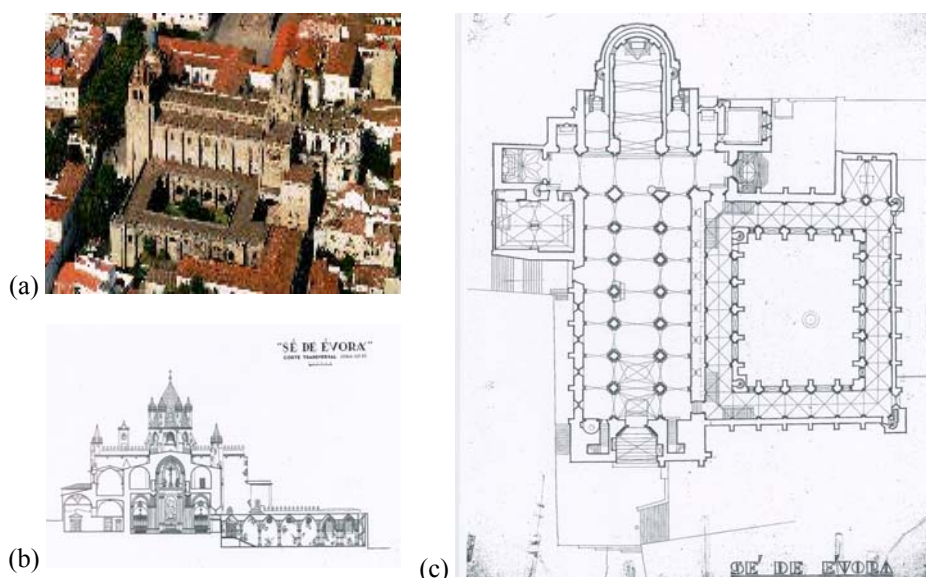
Peças desenhadas [Fonte: DGEMN]: (a) fotografia; (b) alçado da fachada (c) planta.
